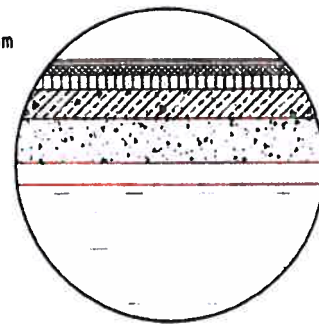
Detail A - STUDIED ROAD STRUCTURES / Detaliu A - STRUCTURI RUTIERE STUDIATE
